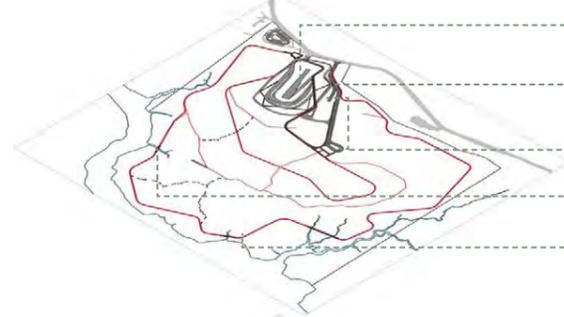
Isométrica de proyecto. Planimetría de elaboración propia.
